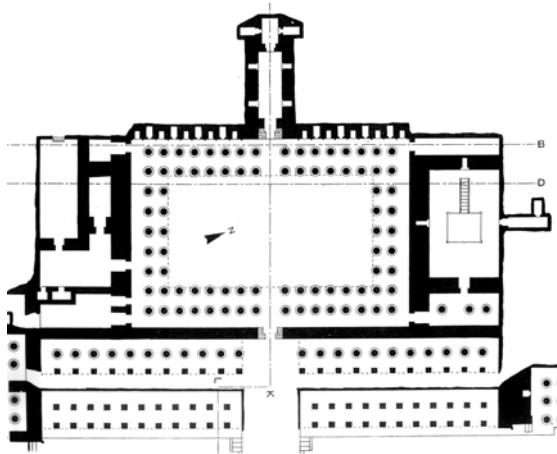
Ausschnitt Grundriss Hatschepsut
